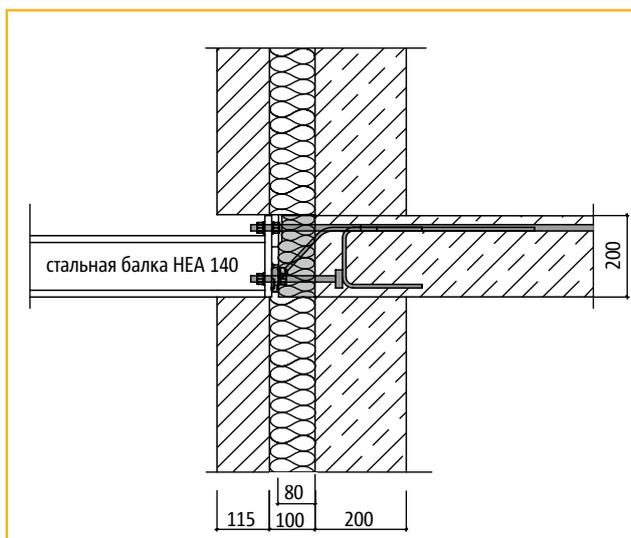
а: Соединение стальной балки HEA 140 с использованием Schöck Isokorb® тип KS 14 для системы с теплоизоляцией
